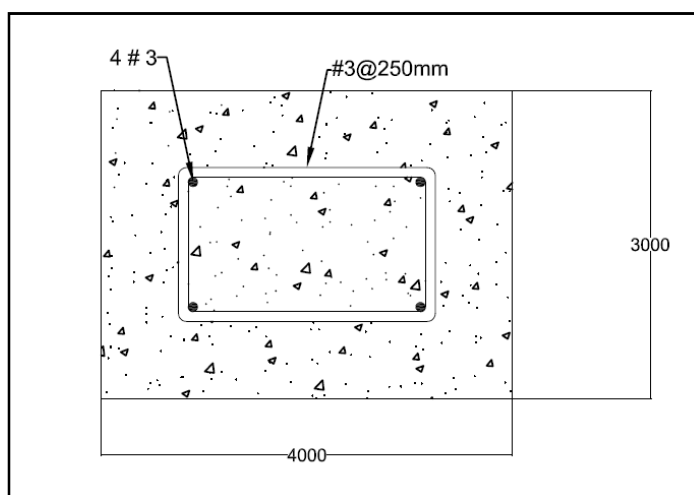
Detalle placa e cimentación muro de retención con suelos reforzado 3 m
